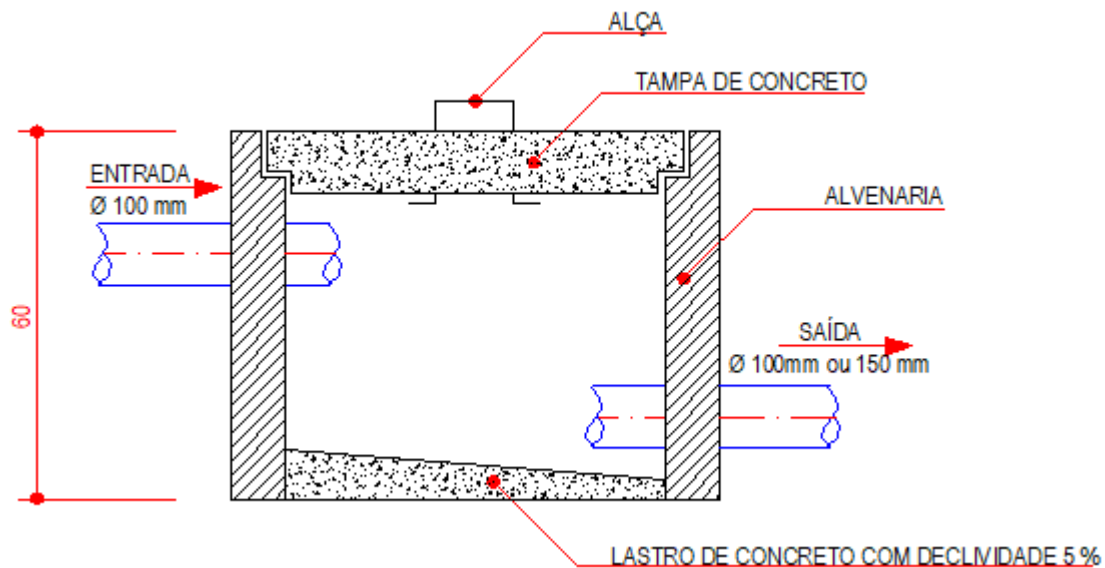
Detalhe esquemático do corte das caixas de passagem. (Ref. projeto Larocca)
